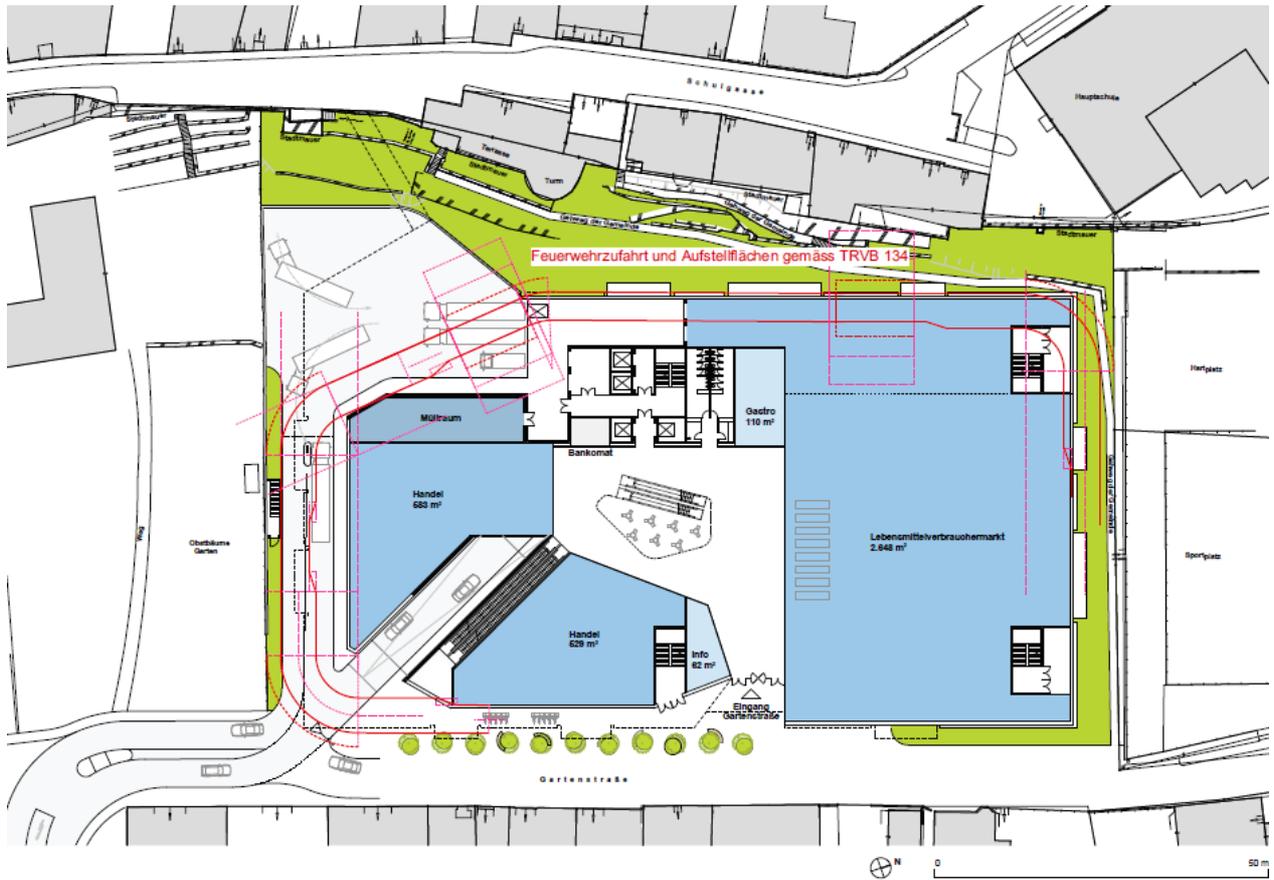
Darstellung der Feuerwehrezufahrt und Aufstellflächen gemäß TRVB 134: Urheber: DI Johannes Kislinger
